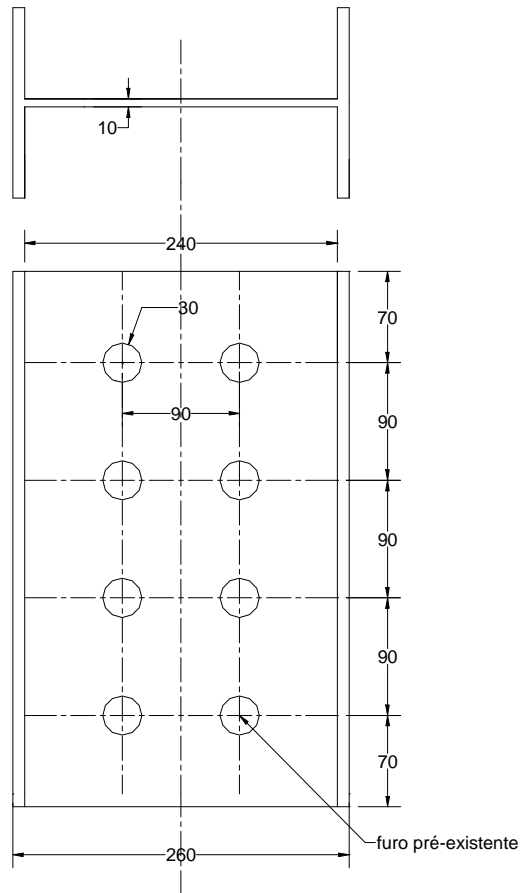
Plano de perfuração do perfil metálico (dimensões em mm).
